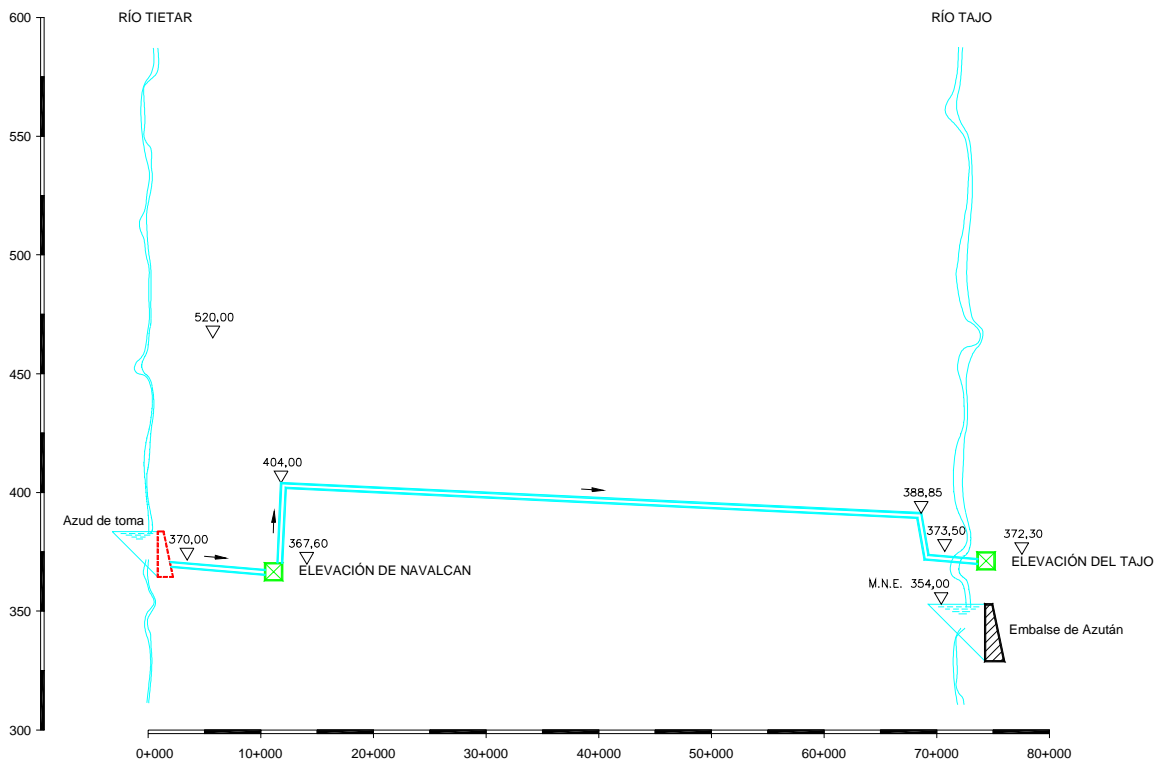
Conducción Tiétar-Aldeanueva. Esquema en alzado
